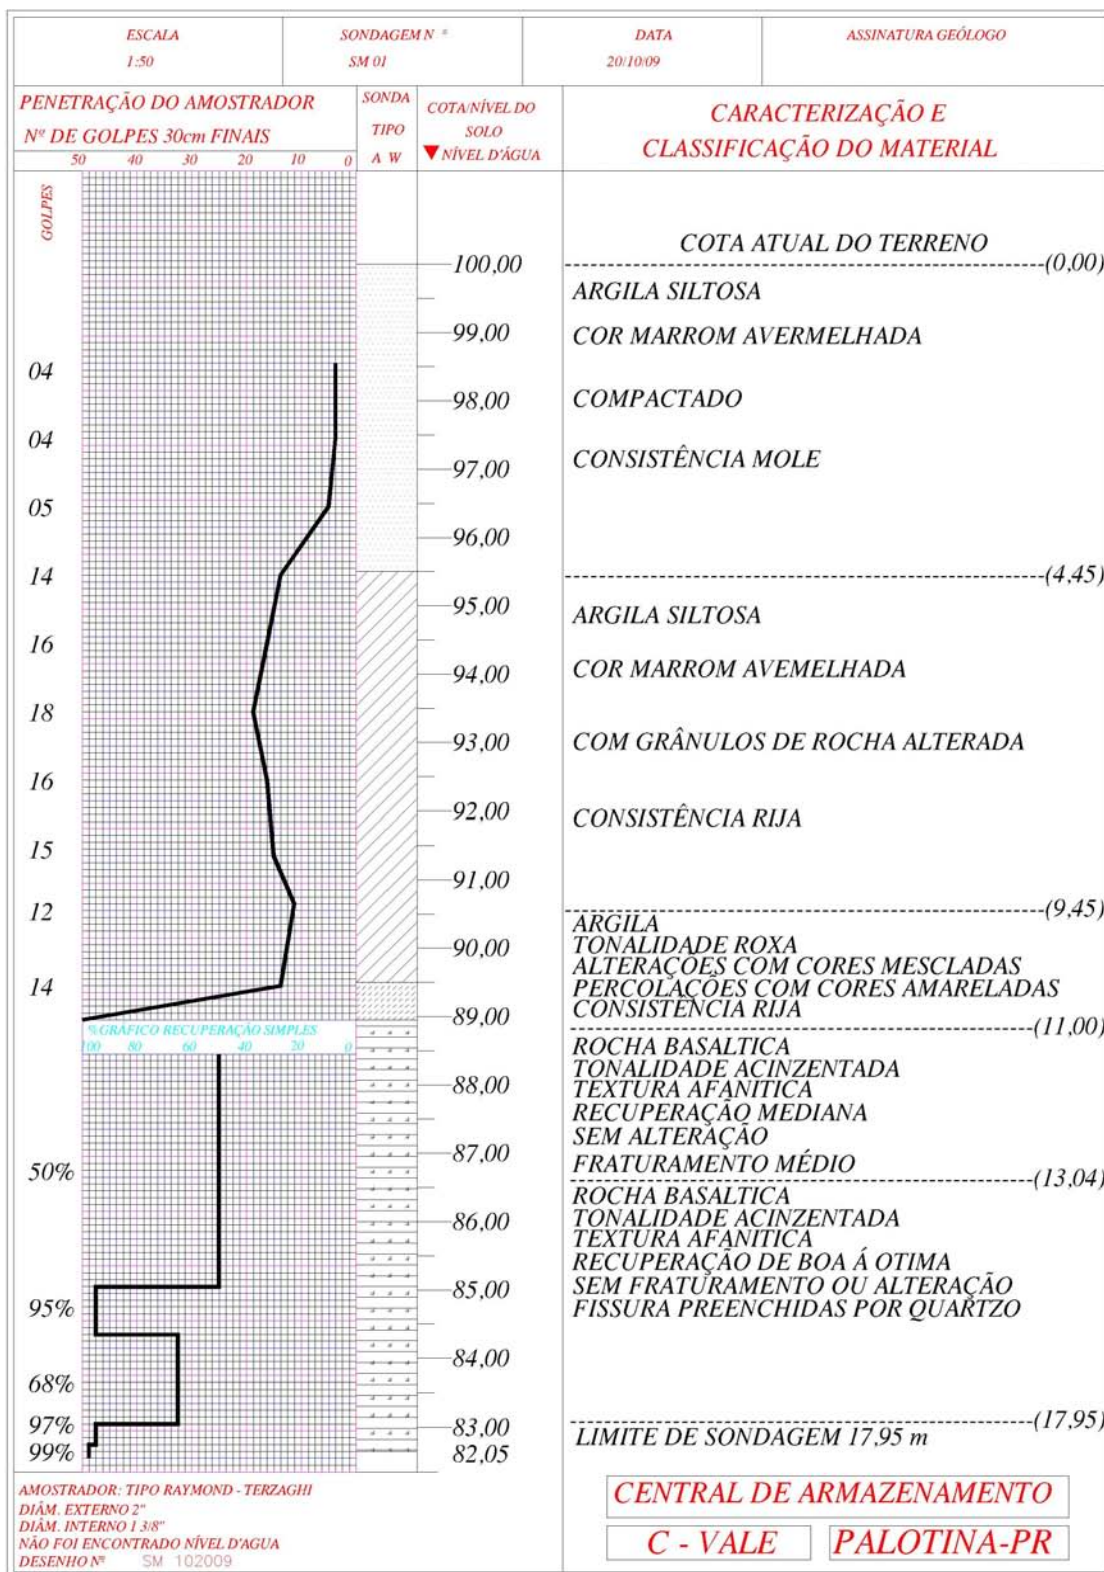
Perfil Sondagem Mista (SM) furo 01.
